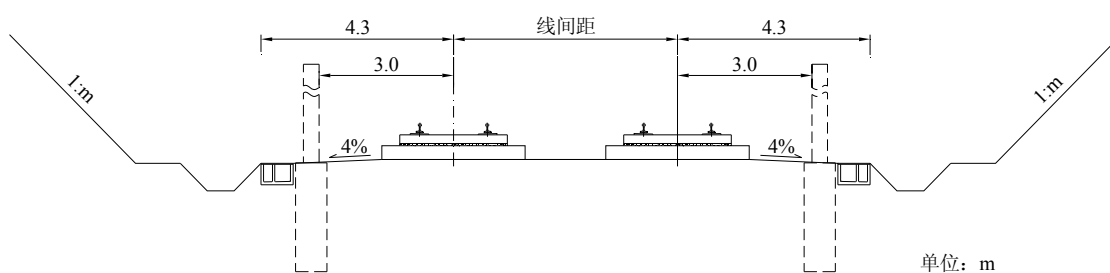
无砟轨道双线硬质岩路堑标准横断面示意图
